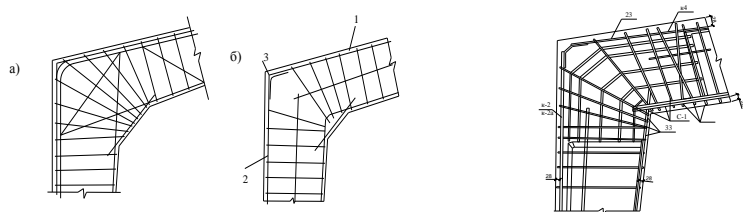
Армування вузла з'єднання ригеля зі стояком: а- гнутими арматурними стержнями; б- за допомогою гнутої закладної деталі; 1,2- арматурний каркас; 3- гнута закладна деталь
